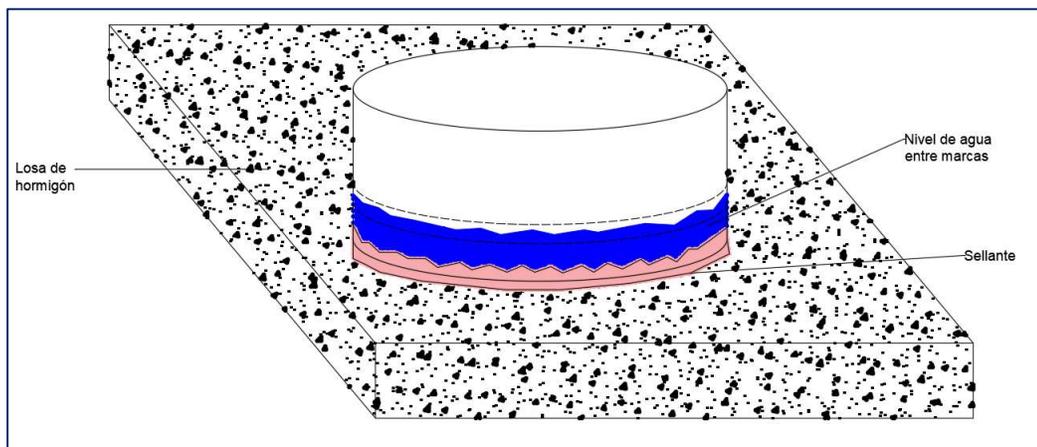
Representación del ensayo de permeabilidad de hormigón permeable
